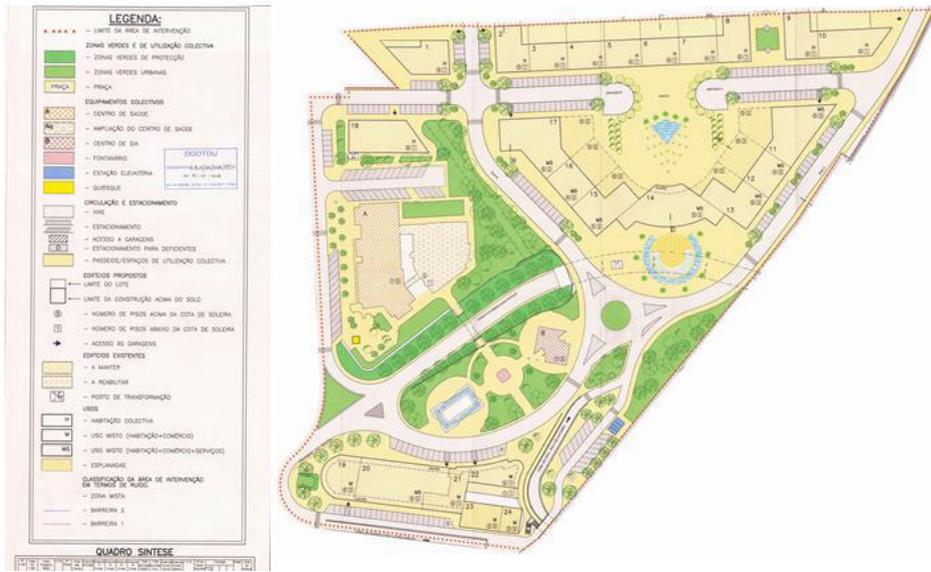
Planta de Implantação do PP da Zona do Centro de Saúde | Fonte: CME
